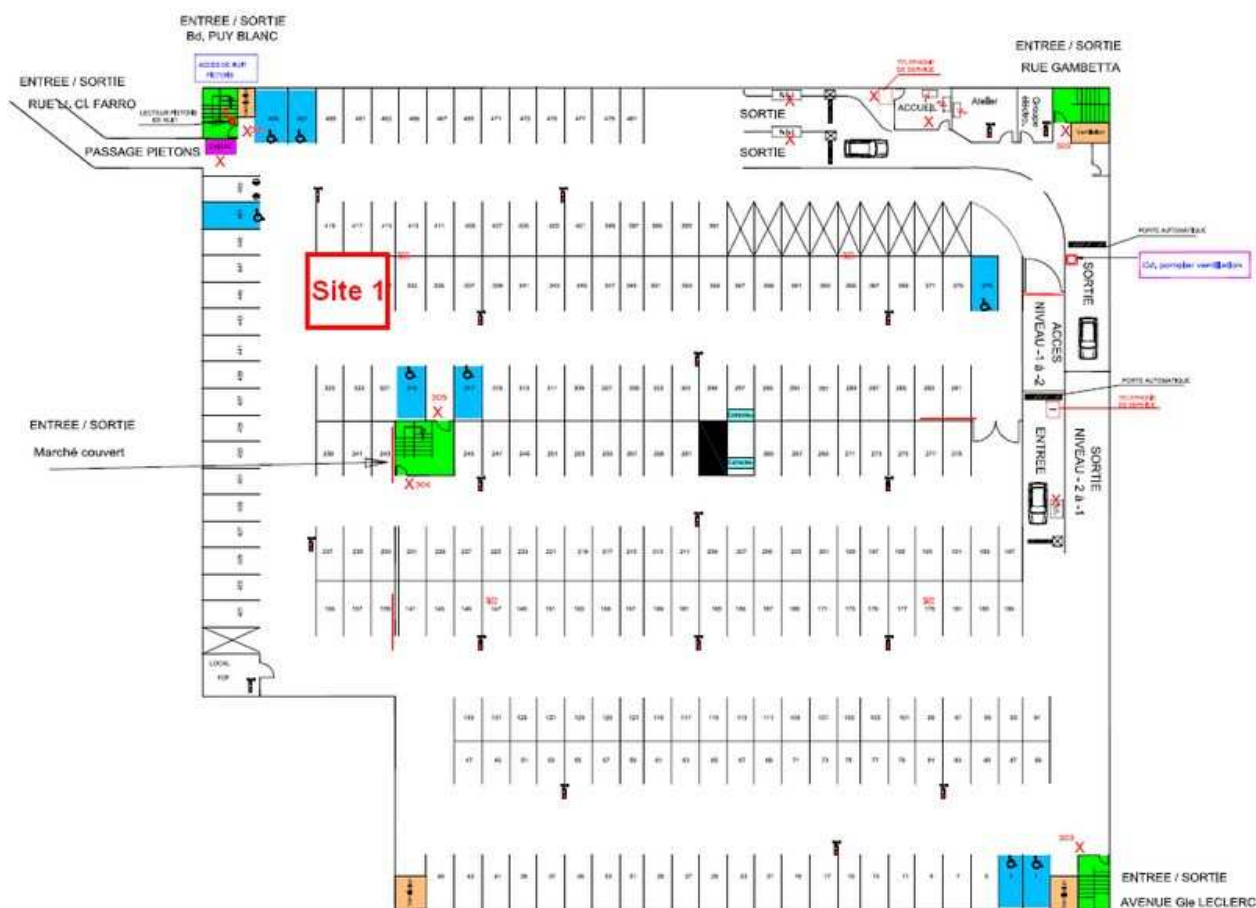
Plan du parking Thiers (niveau -1) avec emplacement du site de mesure
